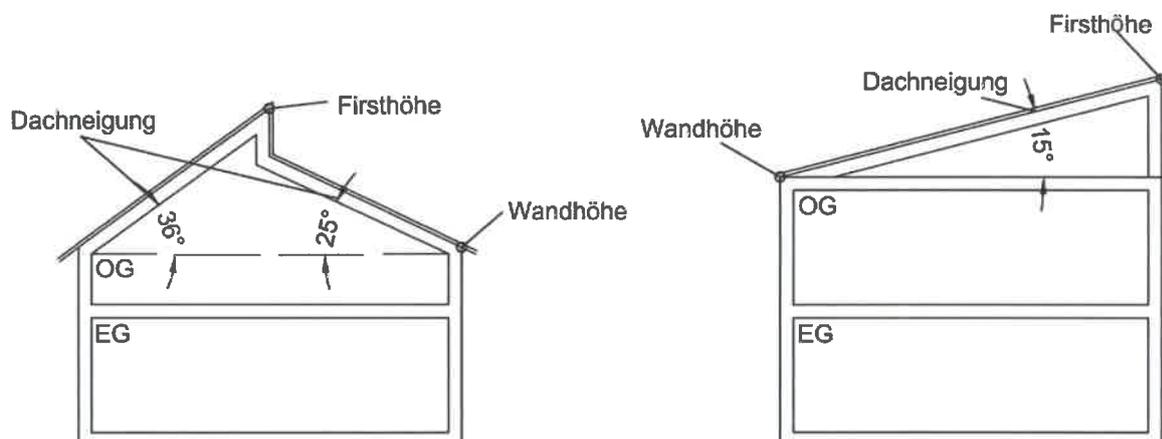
Erläuterung Dachformen und -neigung, Bsp. versetztes Satteldach (links) und Pultdach (rechts)
